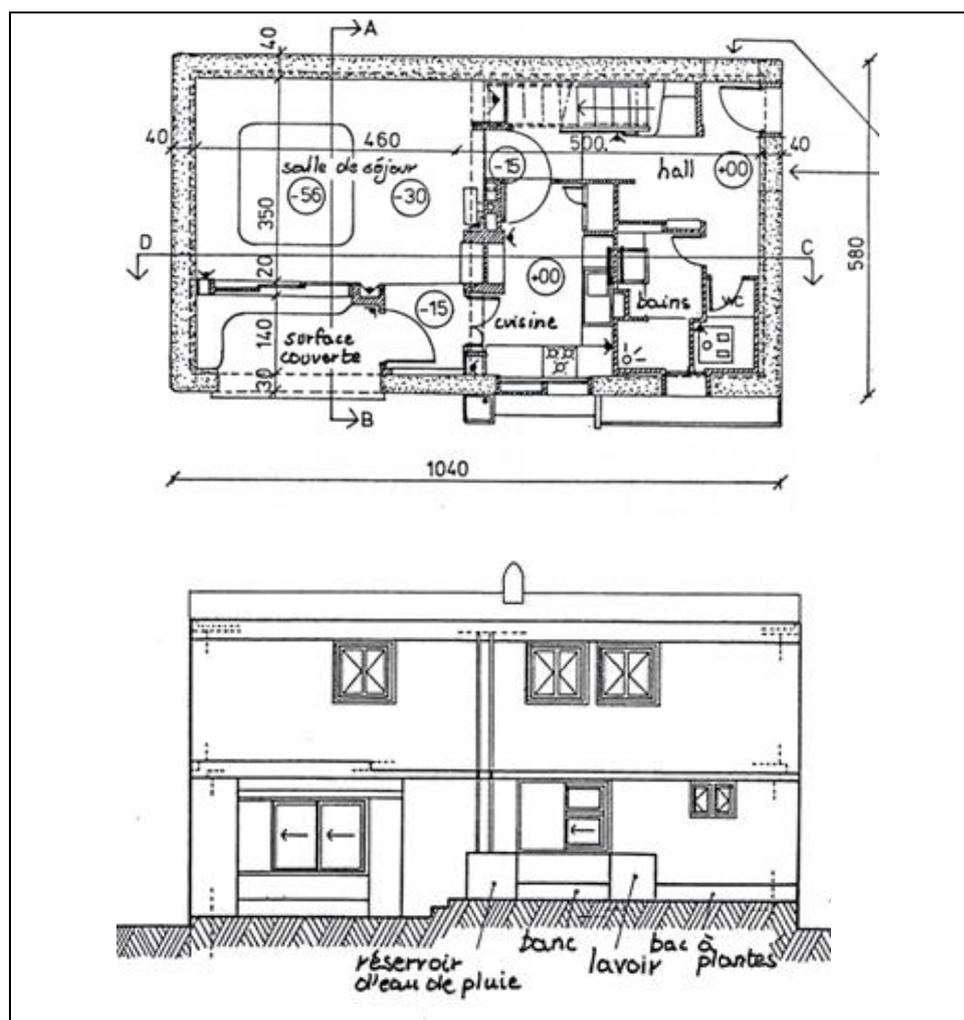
Plan et façade d'une habitation type au village Mustafa Ben Brahim(Odul, 1983)
